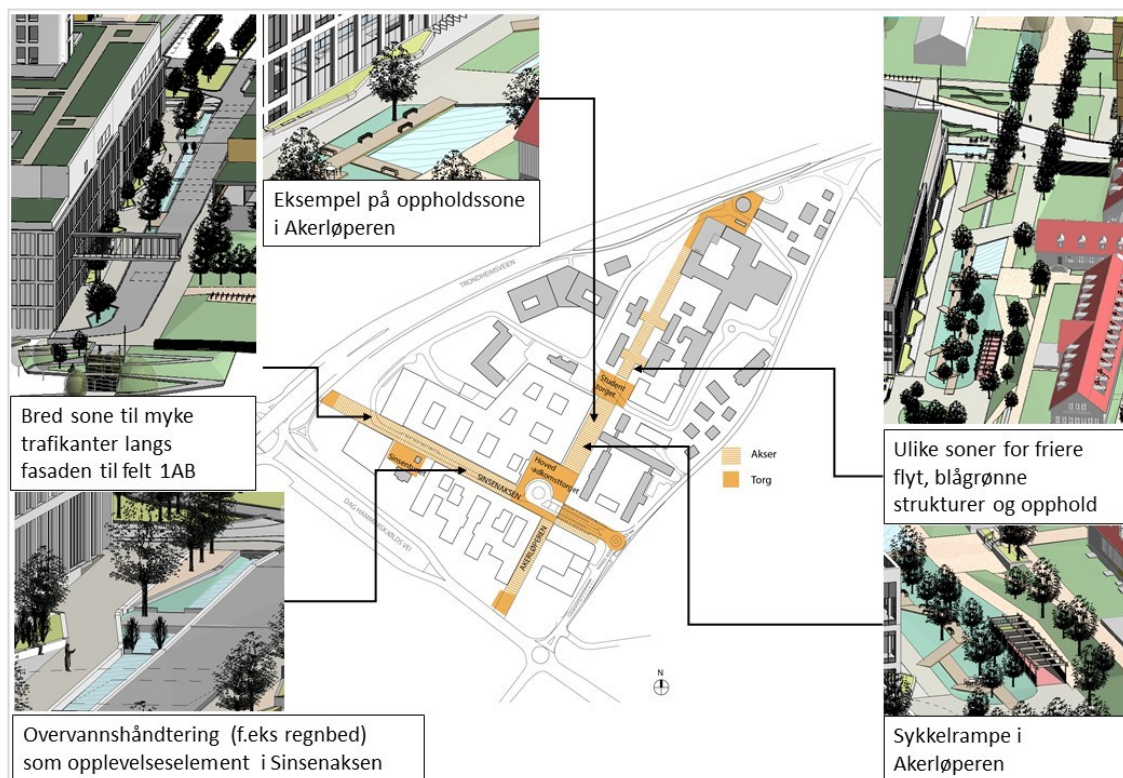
Planområdet med strukturerende elementer og grøntarealer
